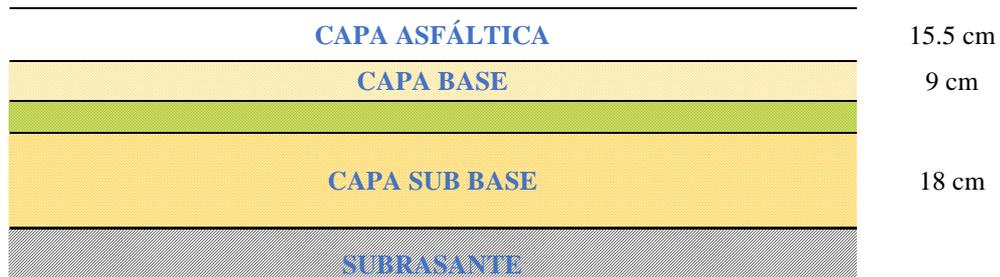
Espesores de Pavimento Flexible con Geotextil
